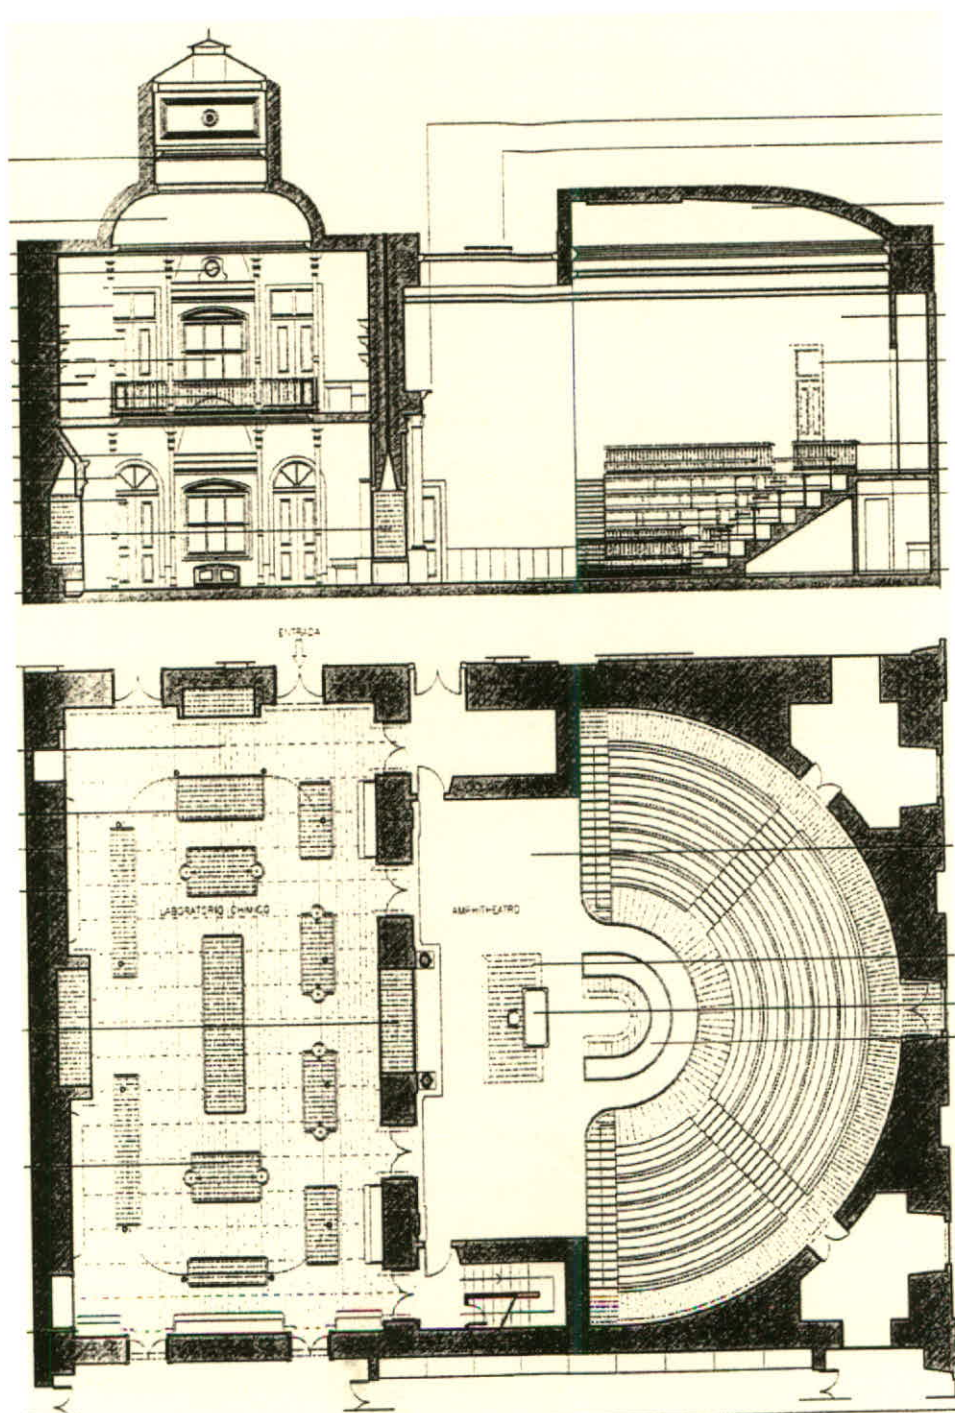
Pormenor do ante-projecto de arquitectura: planta e corte do estudo prévio para a intervenção (Cortesia ARQUI III, 2000).
